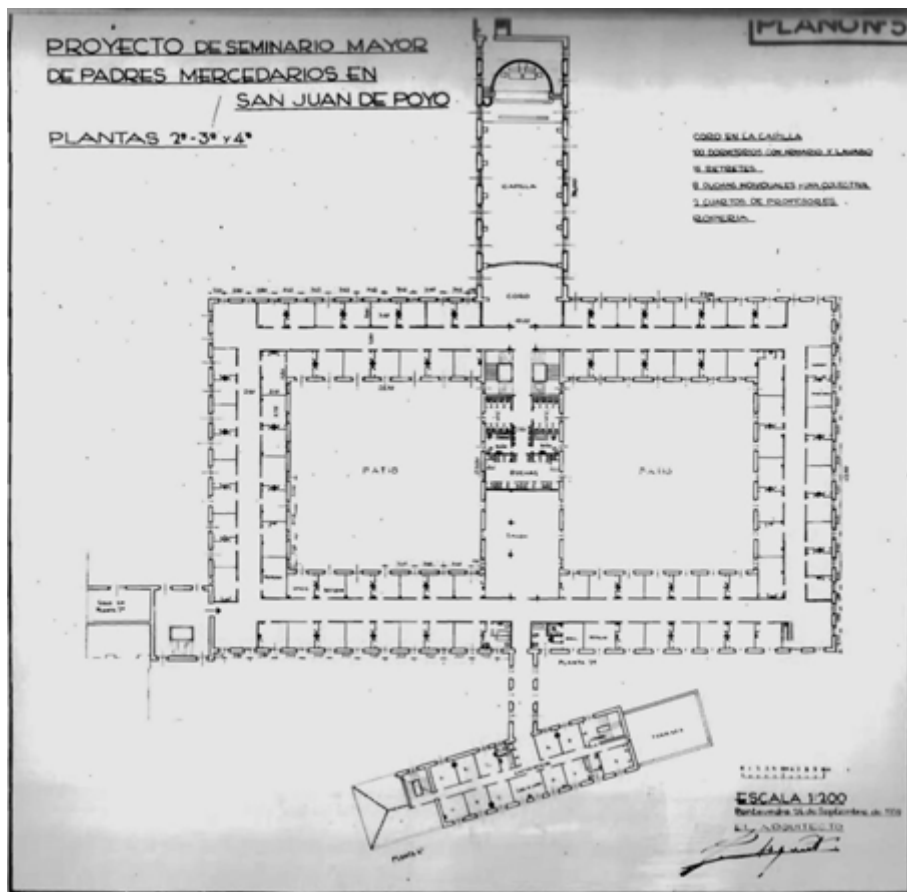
plantas 2ª, 3ª y 4ª. Fuente: Archivo Provincial.
